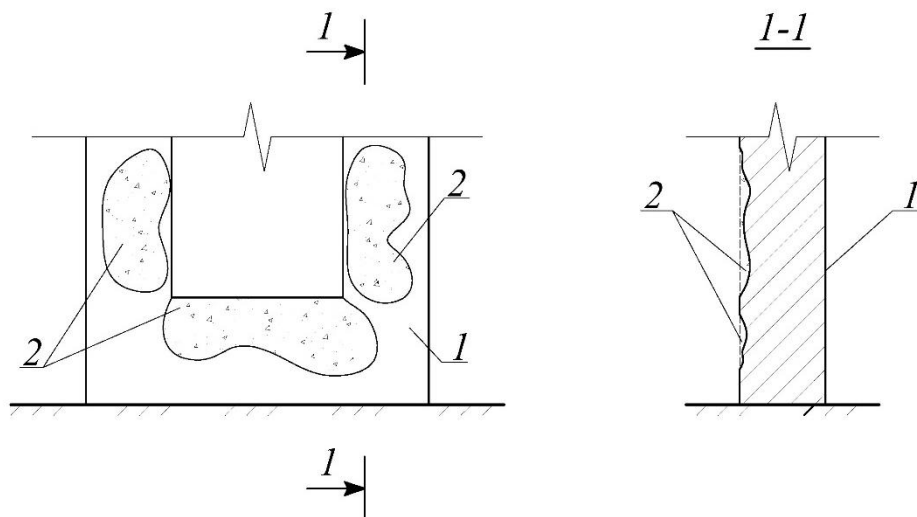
Разрушение наружного слоя кладки стен: 1 – стена; 2 – разрушение кладки.
